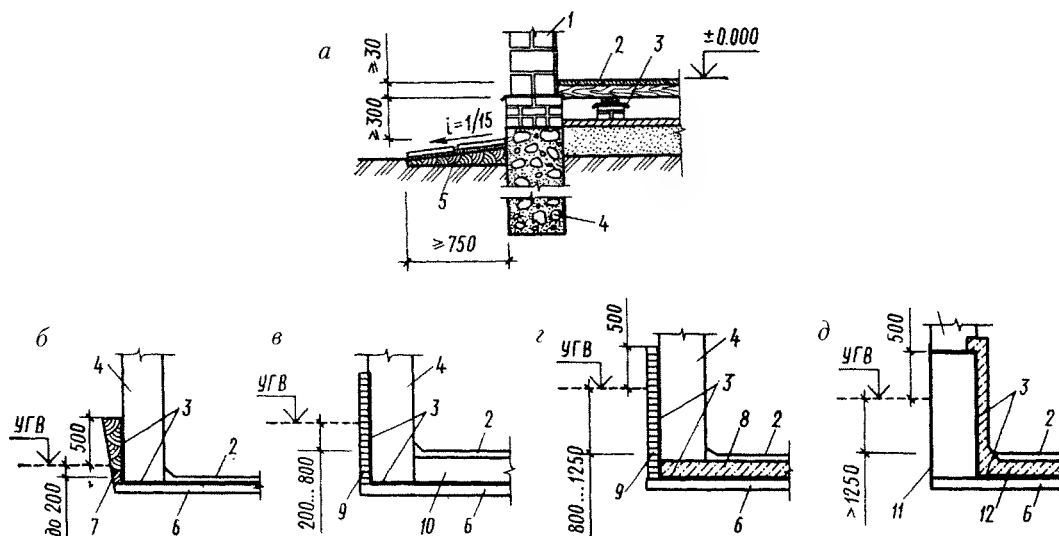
Защита элементов малоэтажных зданий от влаги грунтов:
